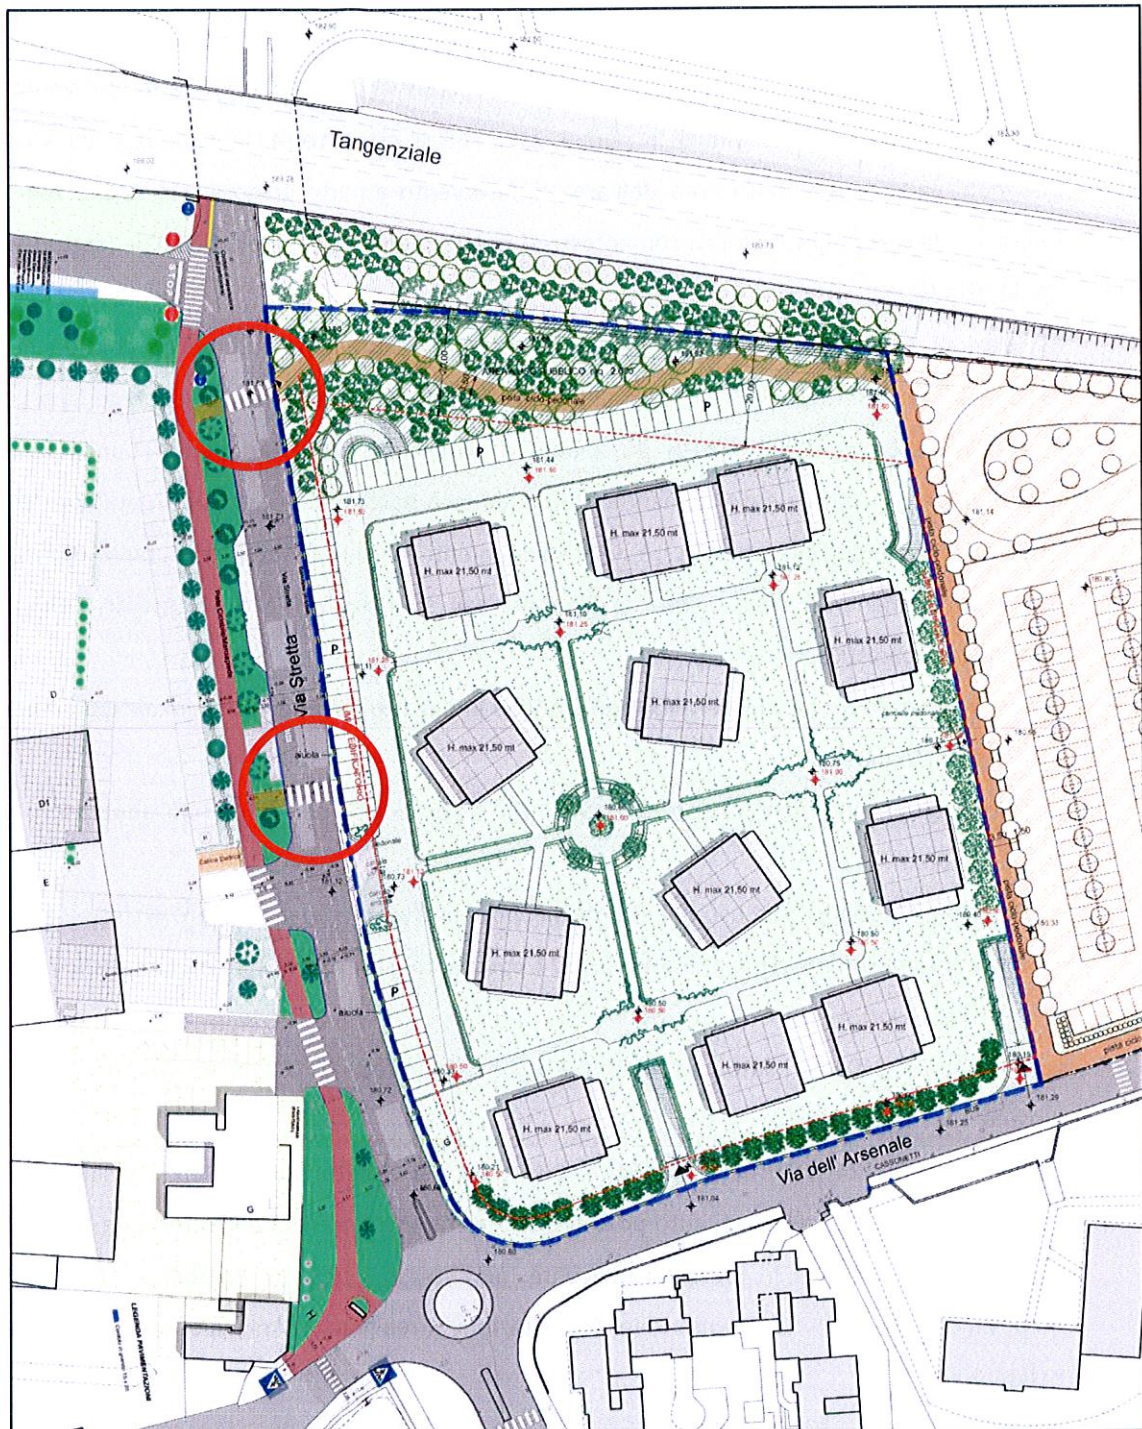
Progetto prolungamento pista ciclo-pedonale lato est e nord e attraversamenti pedonali su Via Stretta
